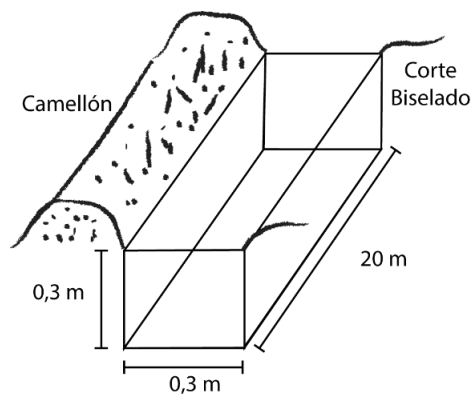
Medidas de zanjas de infiltración. Elaborado por autores según (Pizarro, Flores, Sanguesa, & Et. al, 2008)
